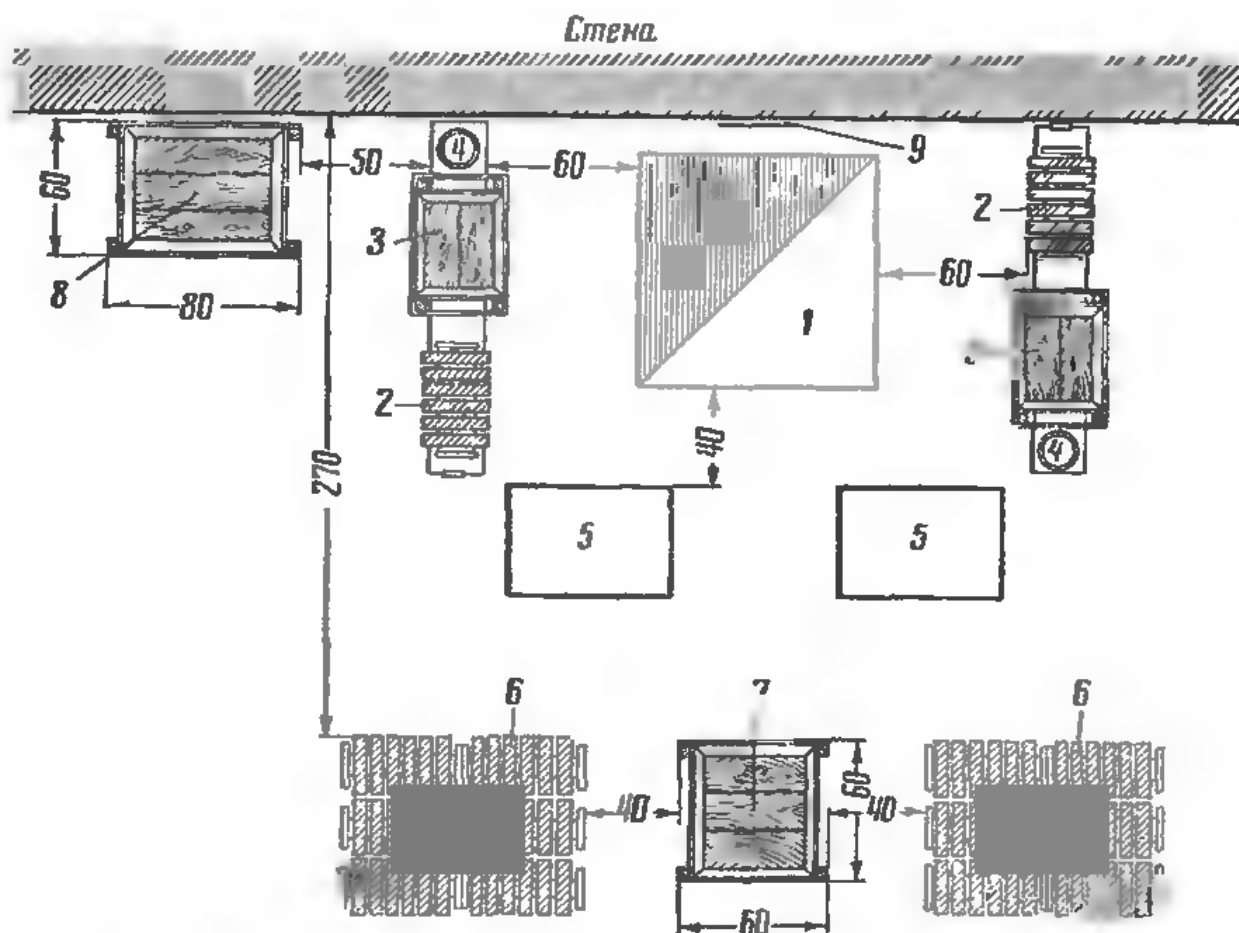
Схема организации рабочего места при кладке печи у стены:
